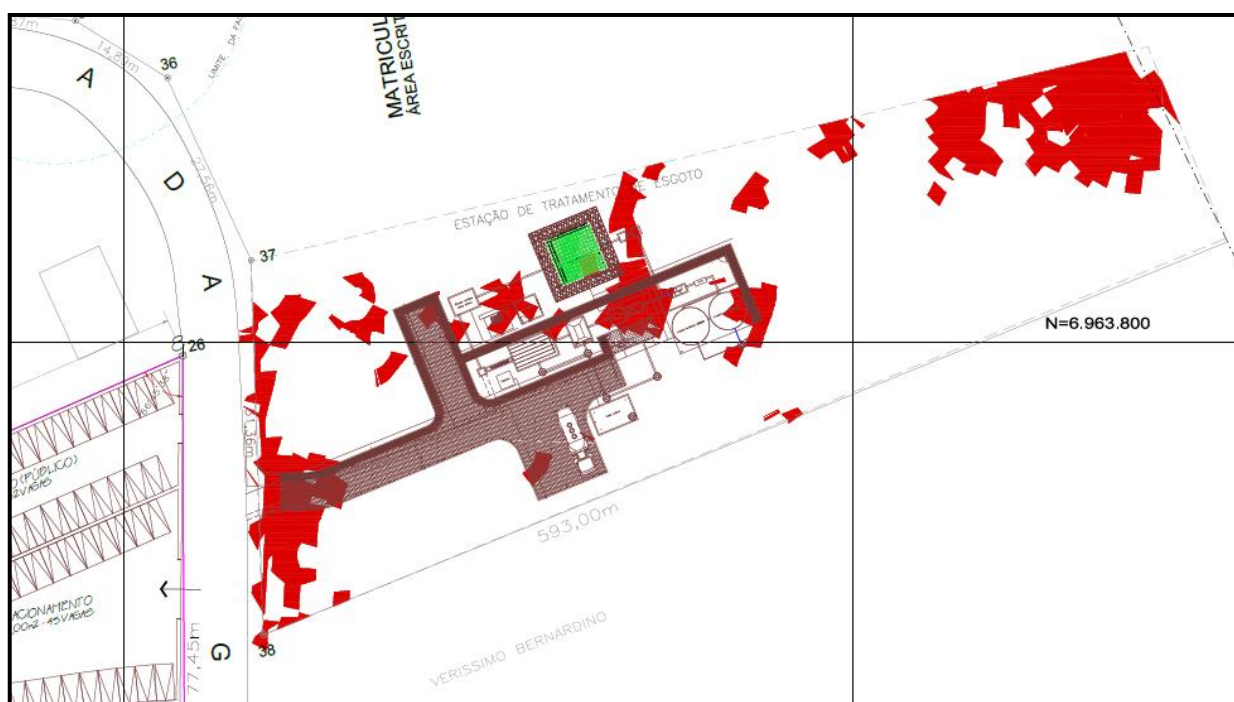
Recorte da Planta do Projeto Xanahi Magic Resort e ETE sobreposta as manchas de declividade entre 25° e 45° (Planta refinada do projeto consolidado).
